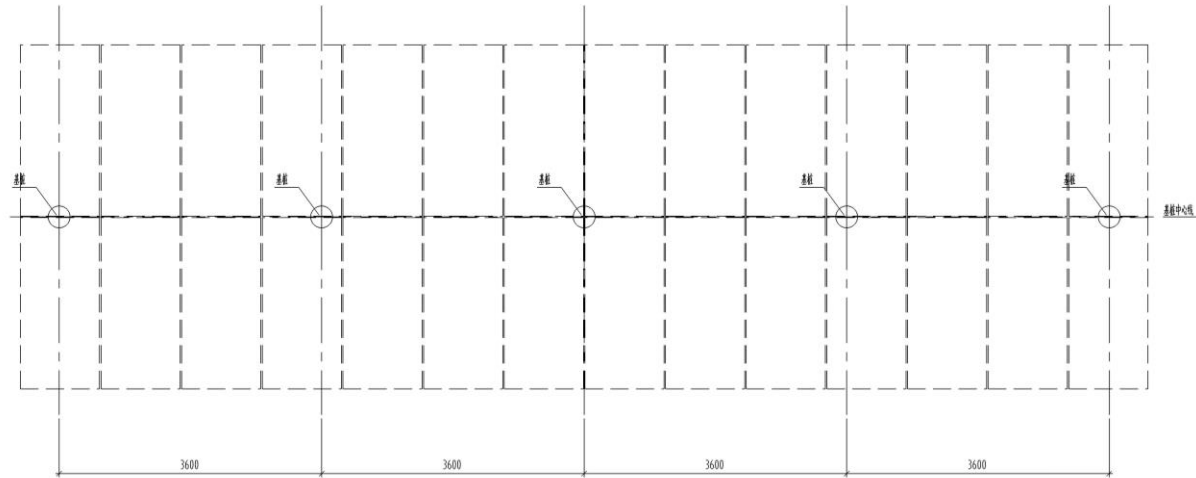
2×14 阵列光伏支架桩基础平面布置示意图
